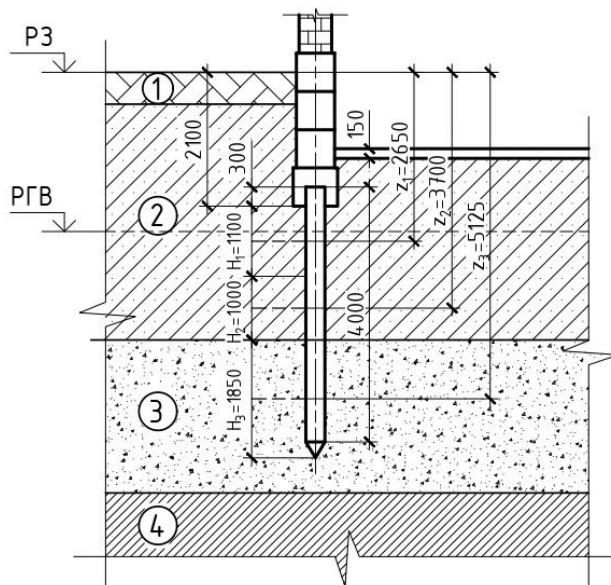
Залізобетонна паля ПНдр4-30
